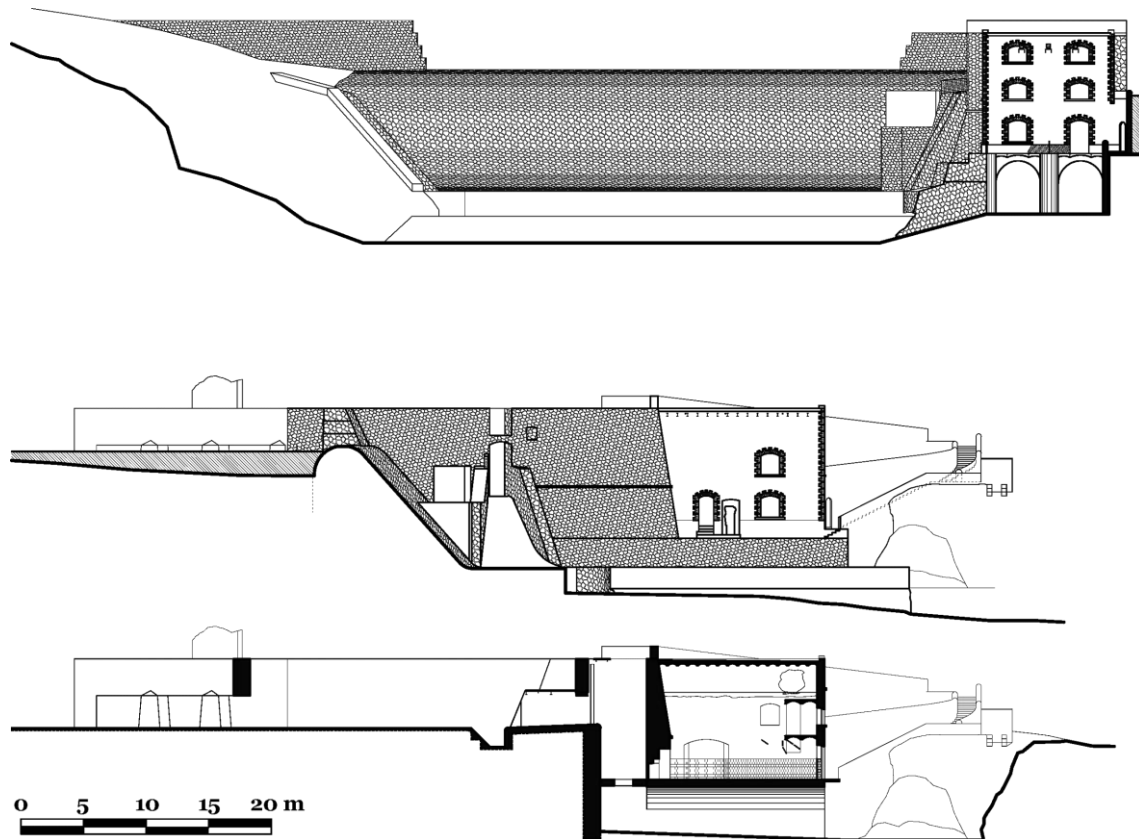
Vistas en alzado de las obras que componen la unidad de producción hidroeléctrica de La Carmelita, de arriba abajo: Fachada poniente, fachada norte y corte longitudinal. Elaborado por el autor
